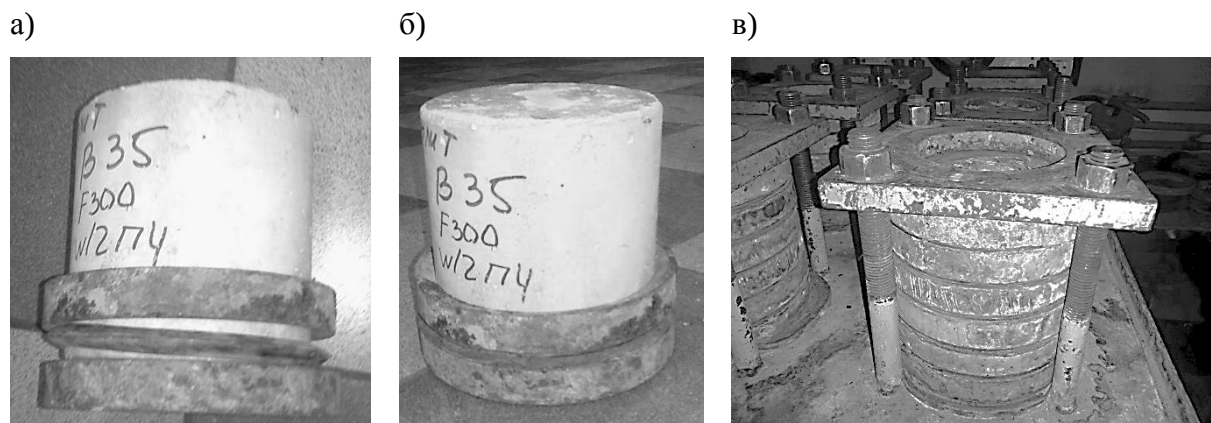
Установка образца в гнездо для испытаний: а, б – установка обоймы; в – образец, установленный в гнездо
